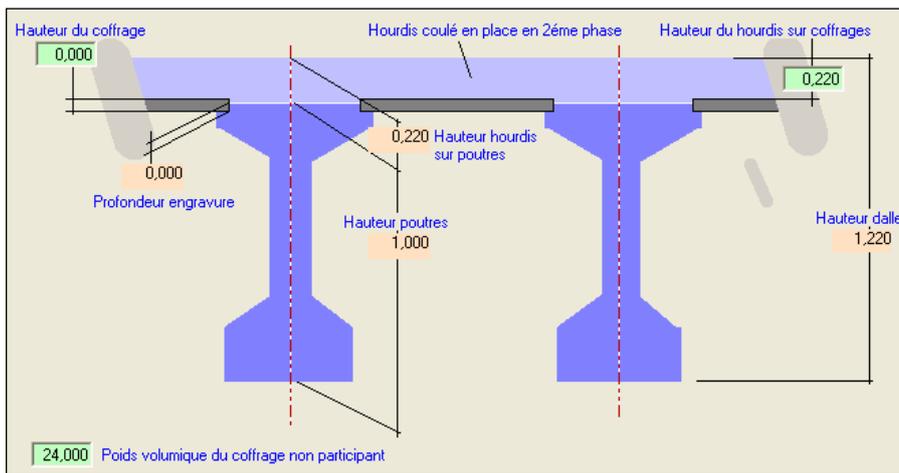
Dimensions du hourdis (ouvrage n°3)
